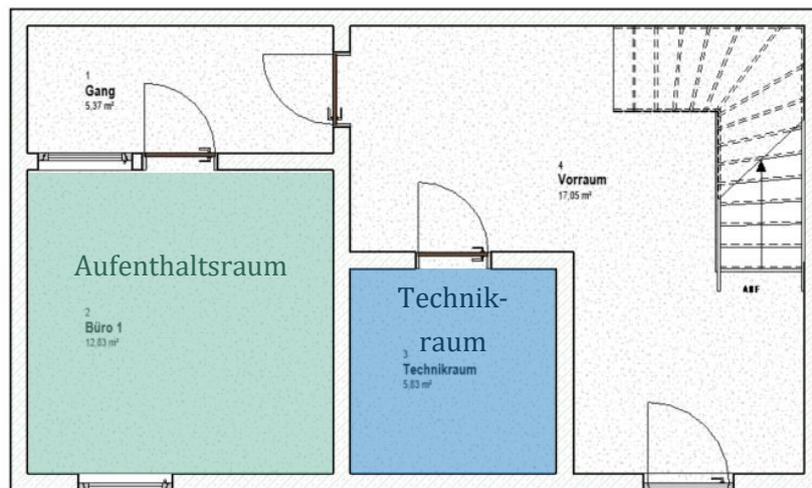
Grundriss EG BIM Modell OIB RL 3 – 11.3.1
